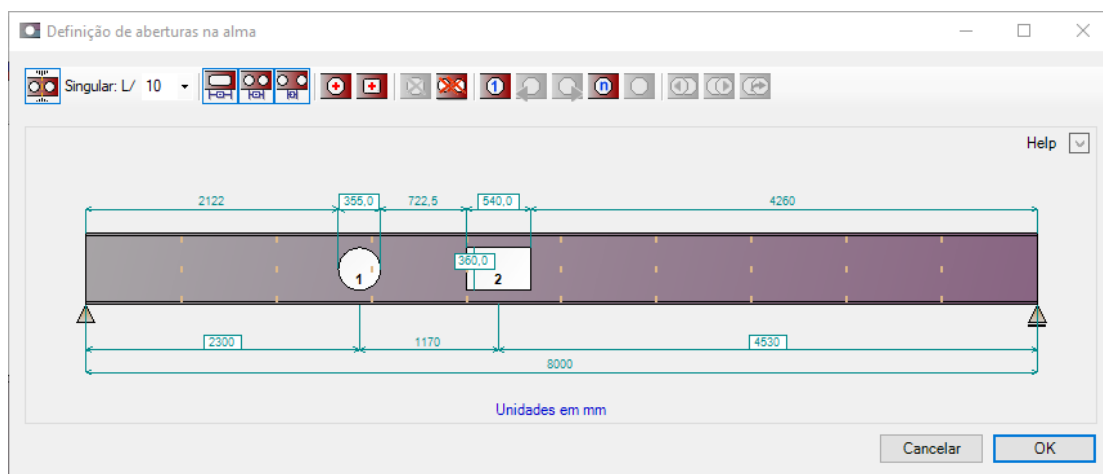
Janela para definição de aberturas especiais na alma da viga.
